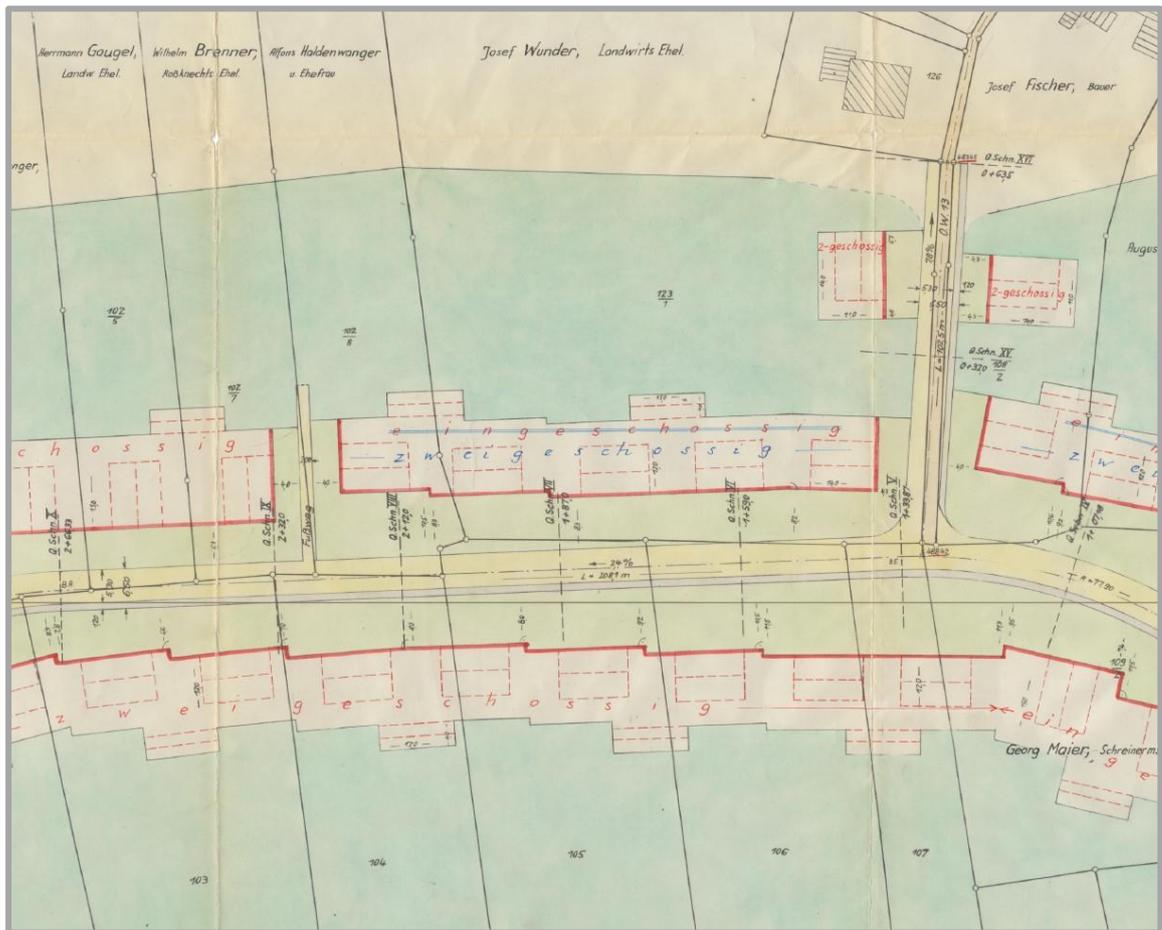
Ausschnitt Baulinienplan „Brühl“, unmaßstäblich
